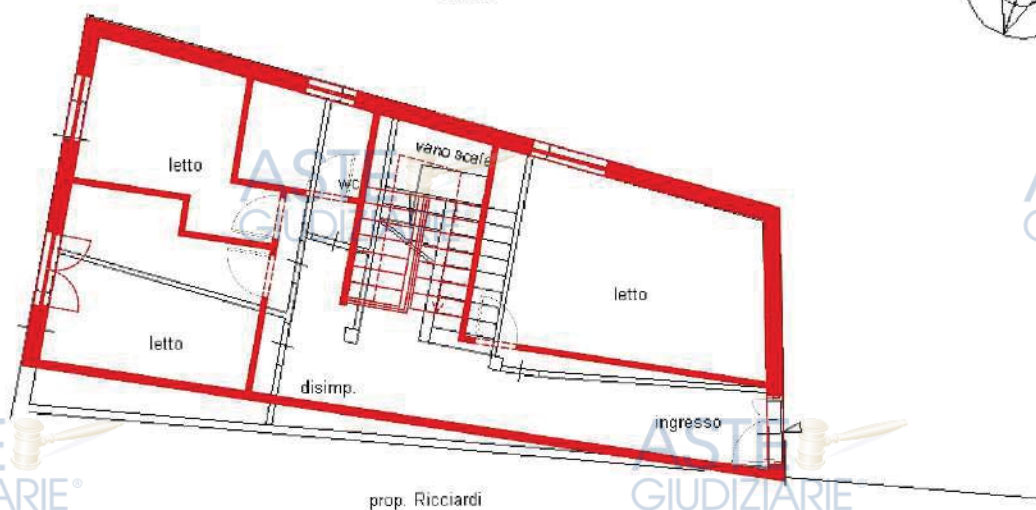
Sovrapposizione planimetria catastali su rilievo stato di fatto (in rosso) - Lotto unico
